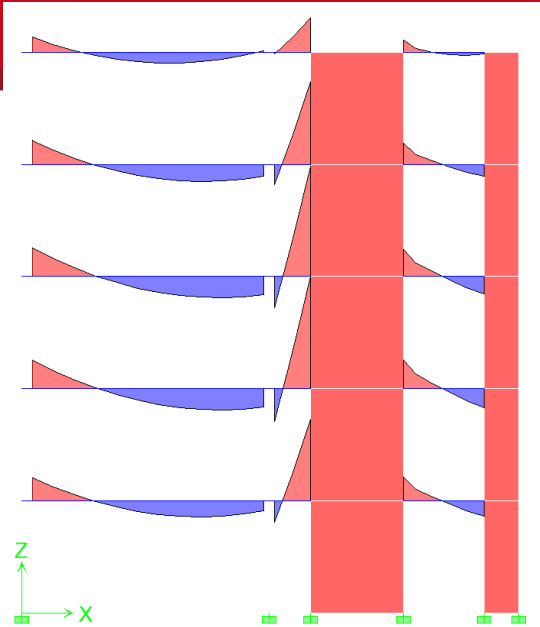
Elevación pórtico eje 4. (Sin restricción de desplazamiento vertical).
